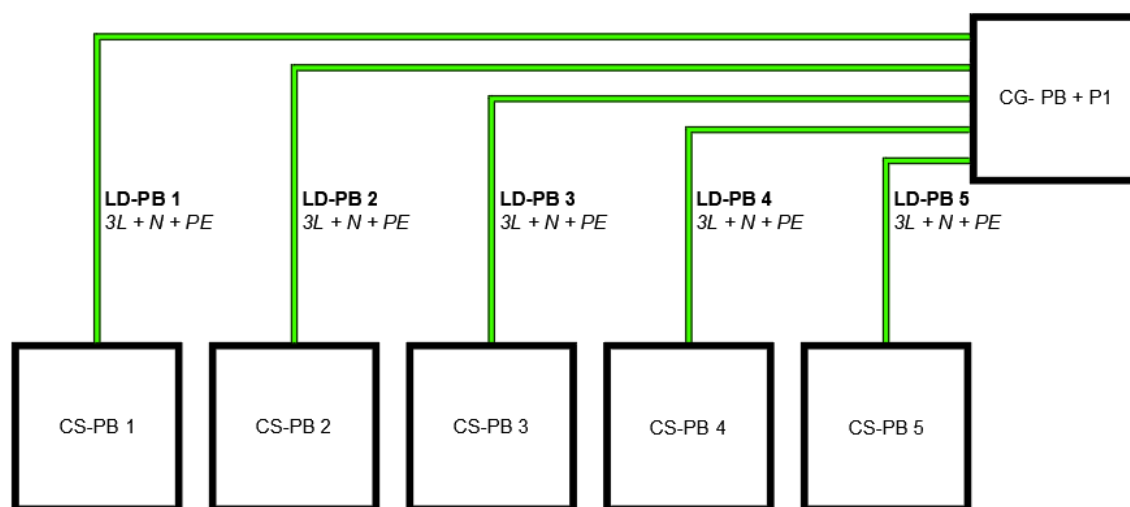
distribución cuadros eléctricos secundarios planta baja
